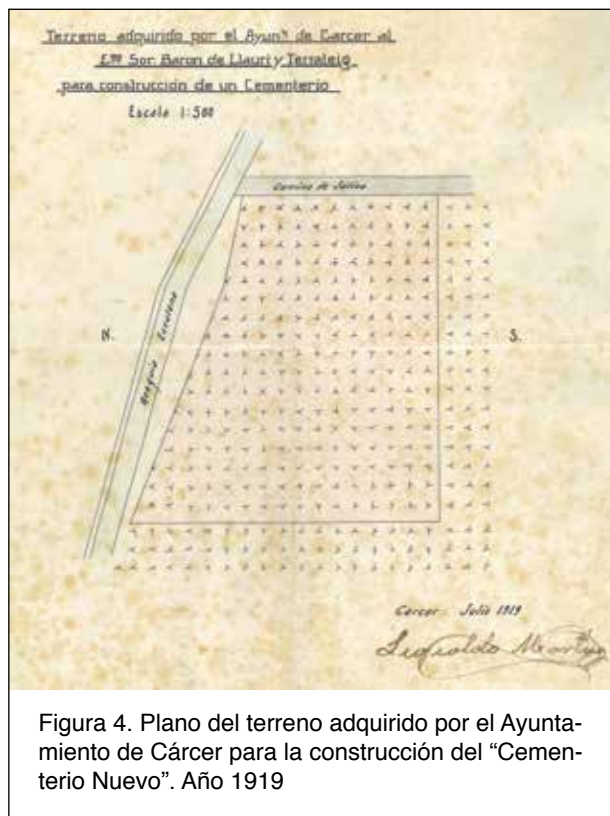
Plano del terreno adquirido por el Ayuntamiento de Cárcer para la construcción del “Cementerio Nuevo”. Año 1919
